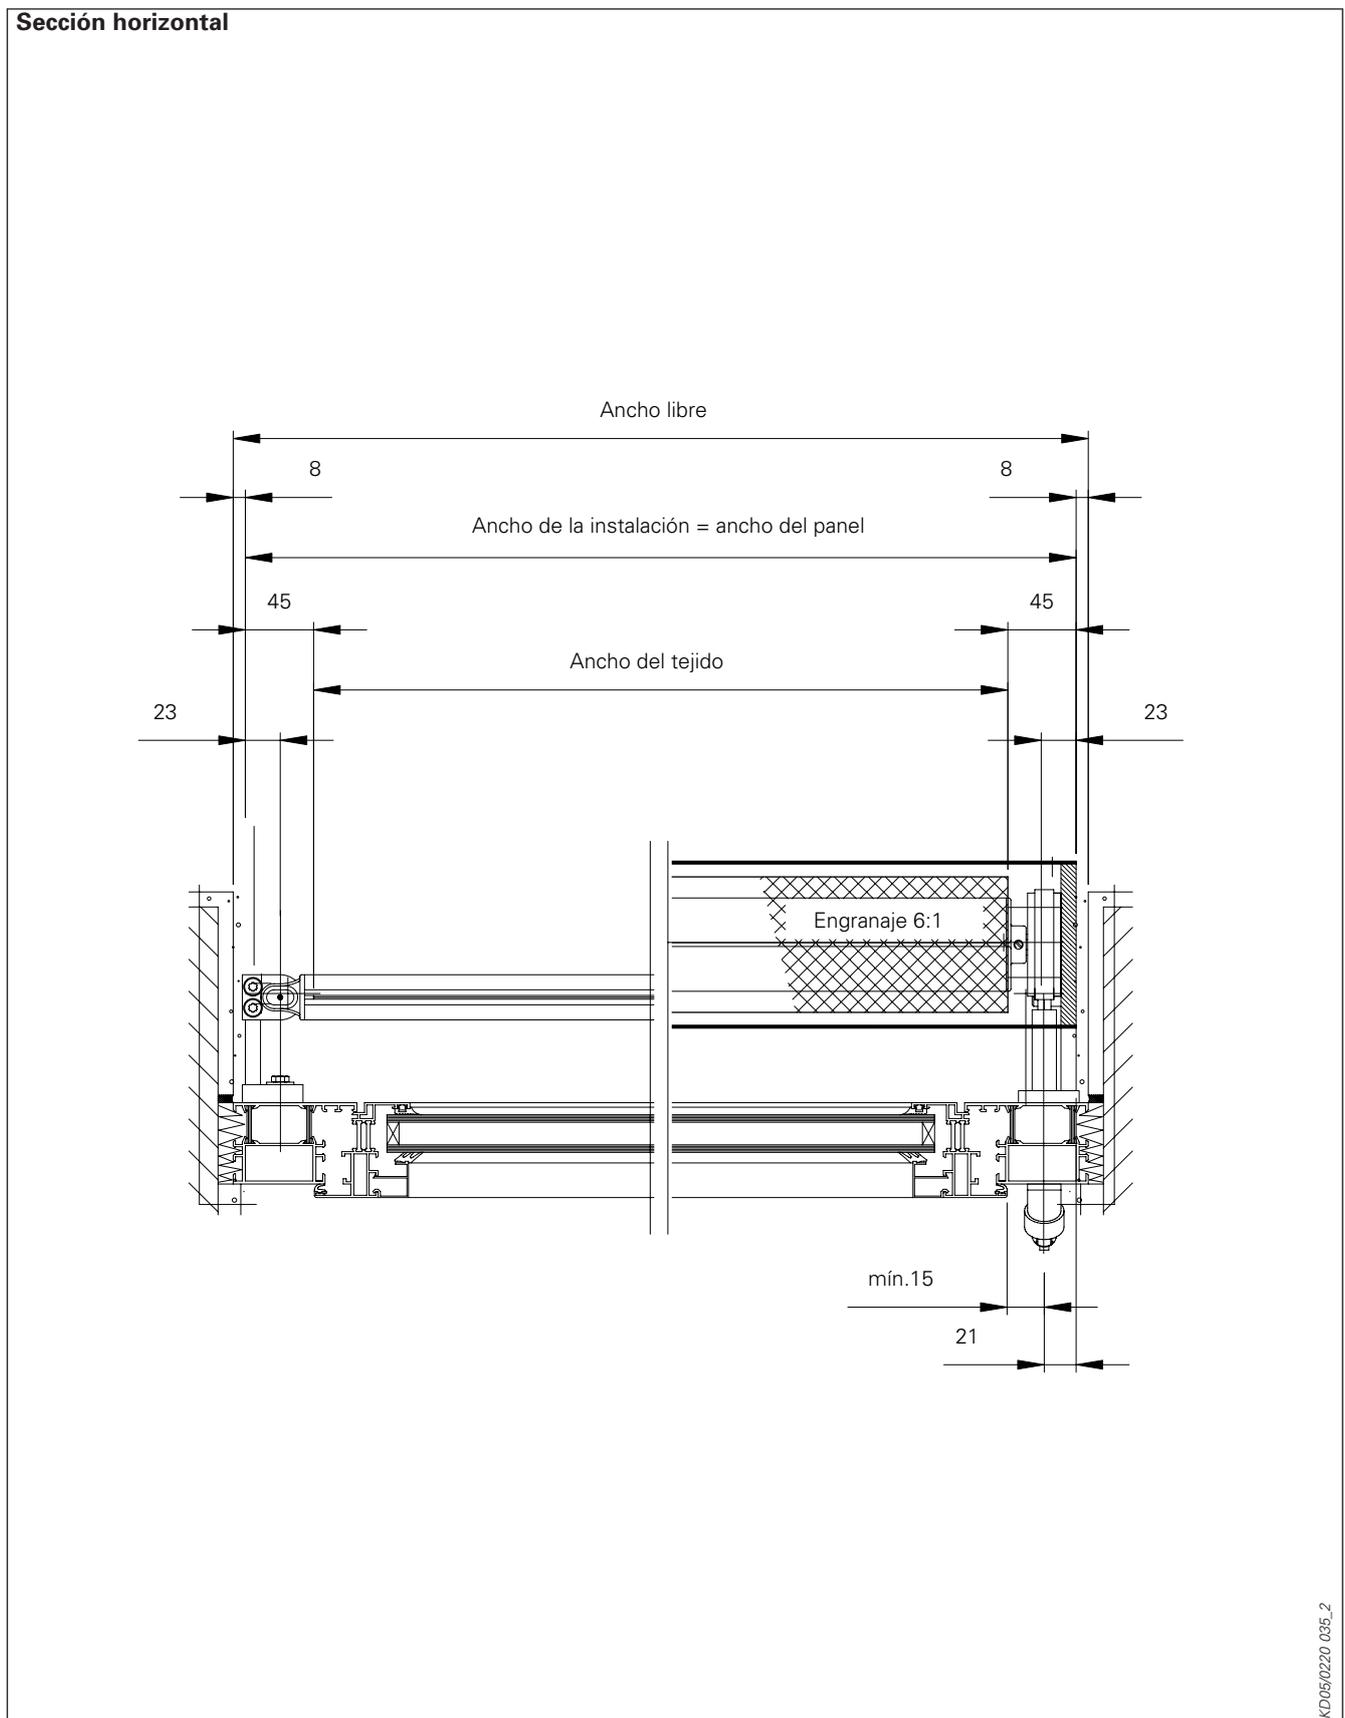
Sección horizontal toldo para fachadas modelo 209 K con protector redondo modelo 23.3 y cable de guía Ø3,3 mm
